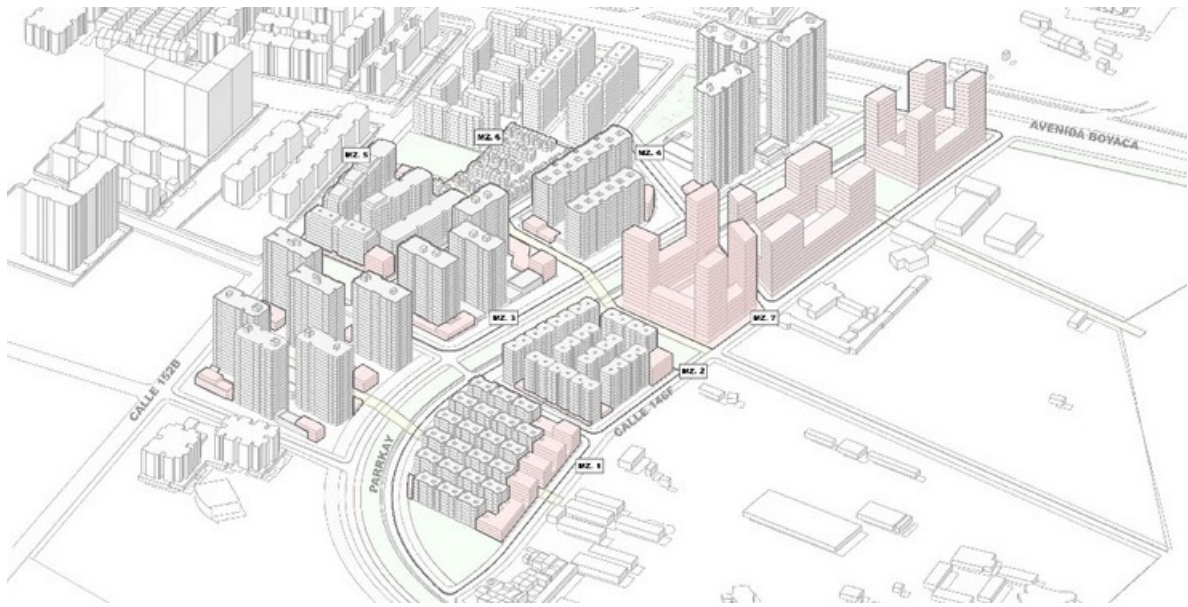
Planta y axonometría con las intervenciones propuestas en color rojo.
